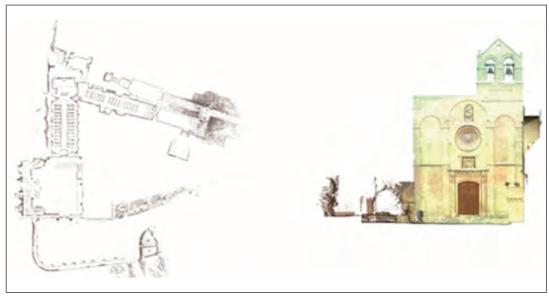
Pianta e prospetto della Chiesa della Palomba.
